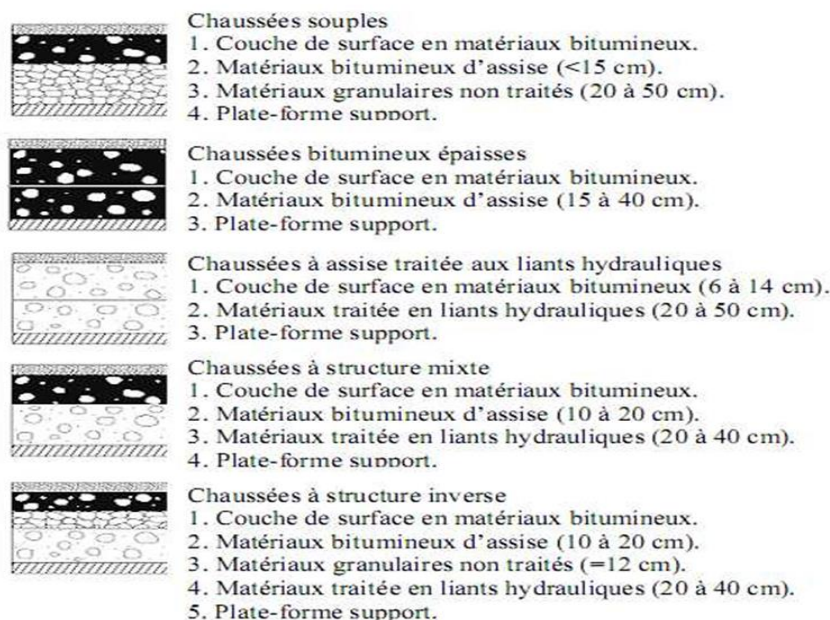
Schéma des différents types de structures de chaussée [11]
